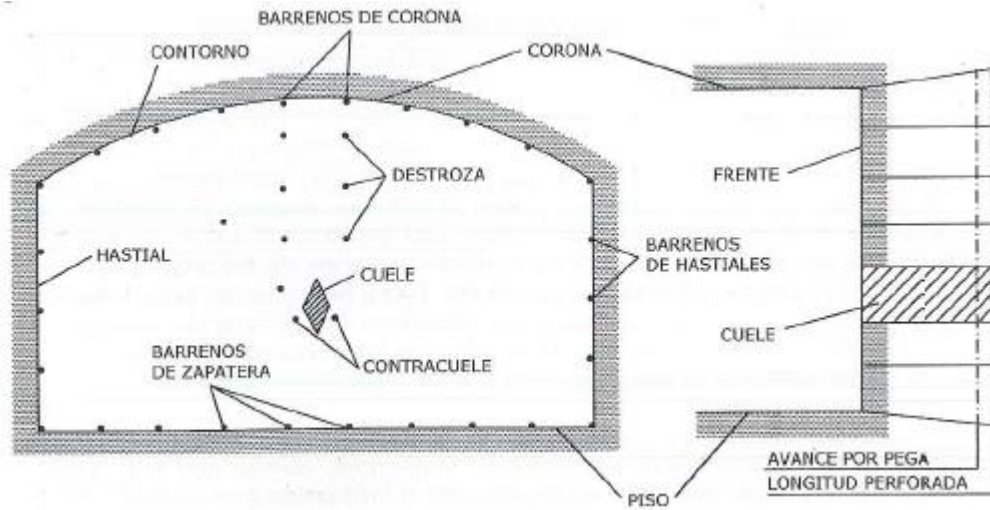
22: Zonas de voladura. (Carlos López Jimeno et al., 2010)
